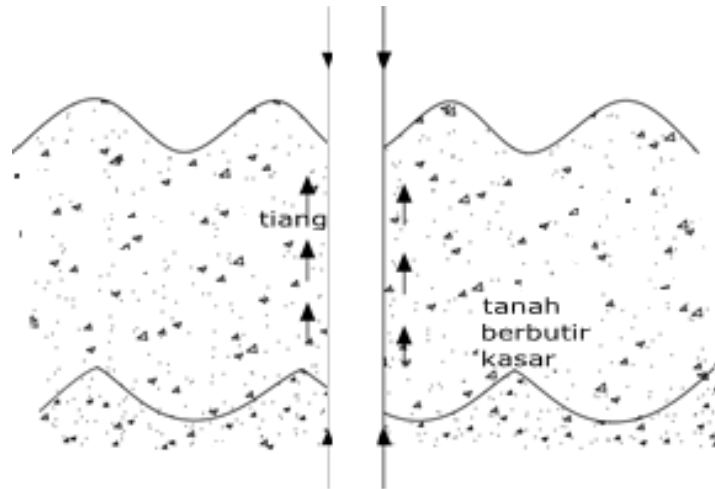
Fondasi tiang dengan tahanan ujung (Ending Bearing Pile)
